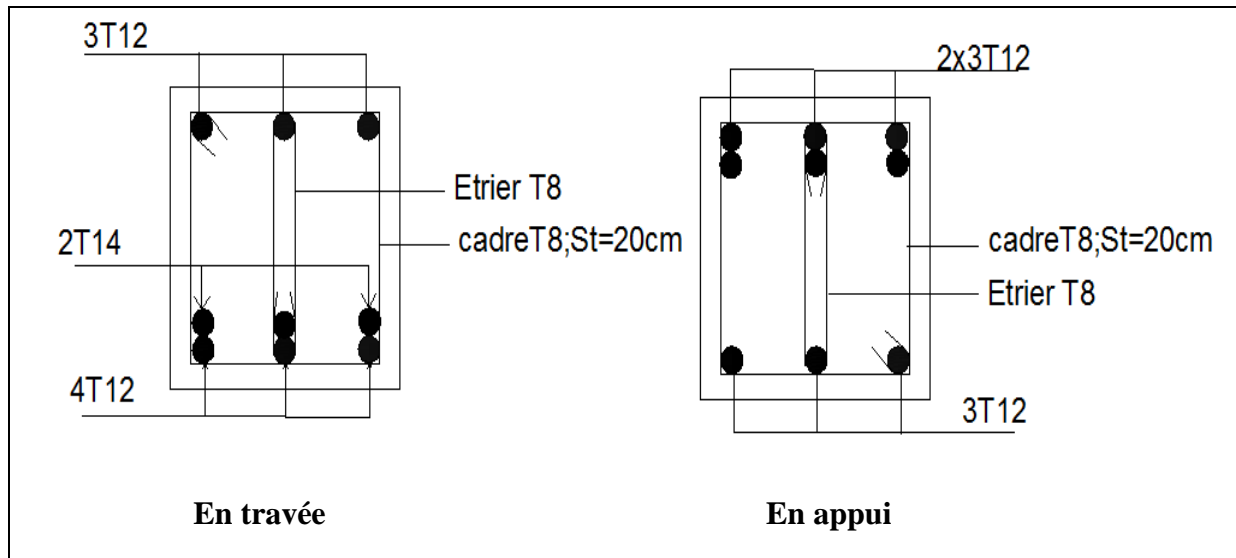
Schéma de ferrailage de la poutre brisée.
